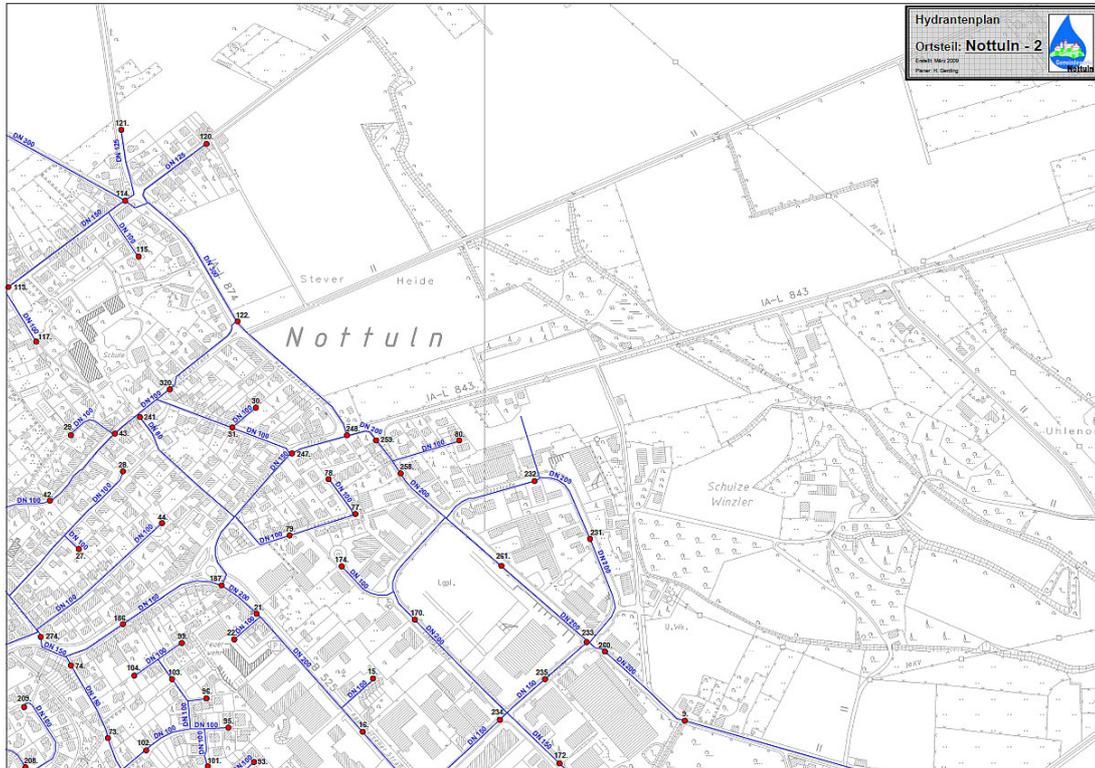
Trinkwasserversorgungsnetz mit Hydranten, Detailplan Nottuln Nordost
